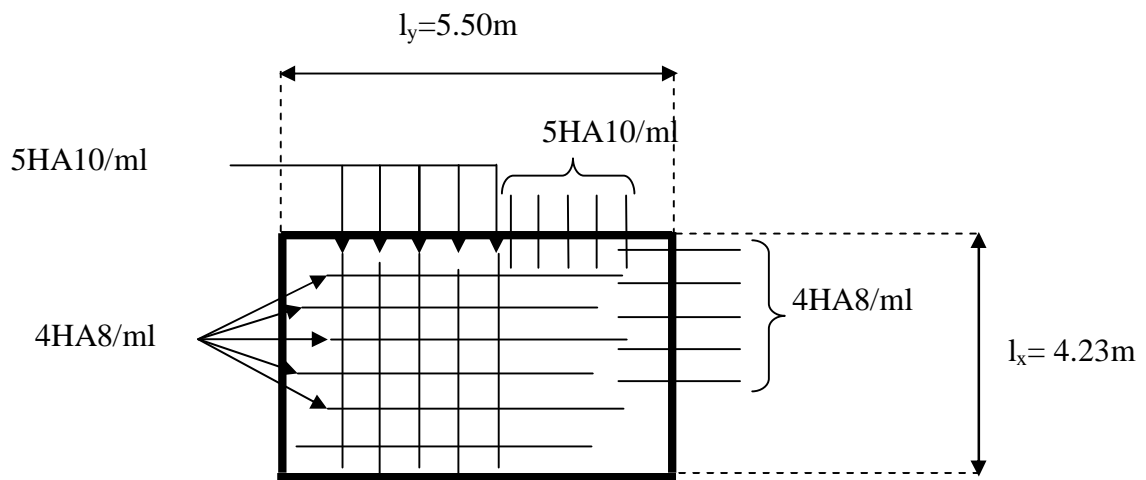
Schéma de ferrailage de la dalle sur 4 appuis (01)
